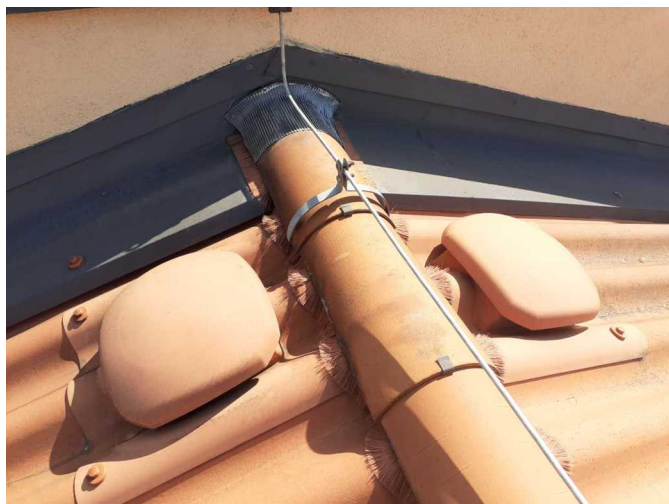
/ Napojení střešního hřebene na zděnou nástavbu nad schodištěm
